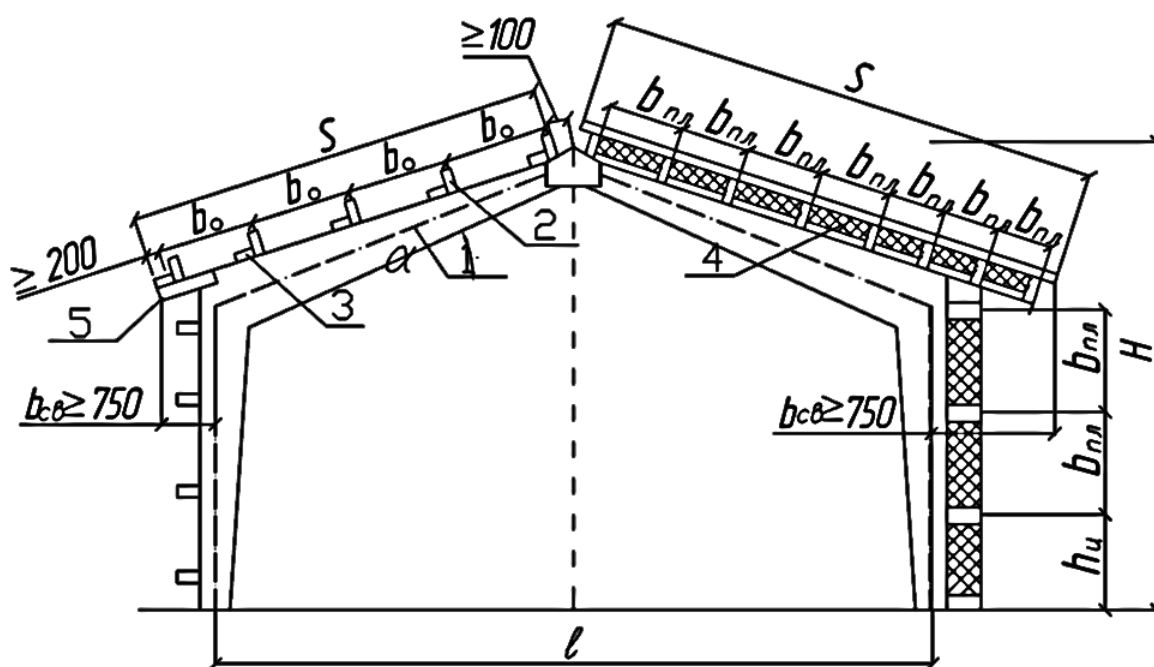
Конструктивная схема ограждающих конструкций зданий с прямолинейным очертанием кровли: 1 – верхний пояс(кромка); 2 – прогон кровли; 3 – бобышки; 4 – трёхслойная панель; 5 – кобылка
